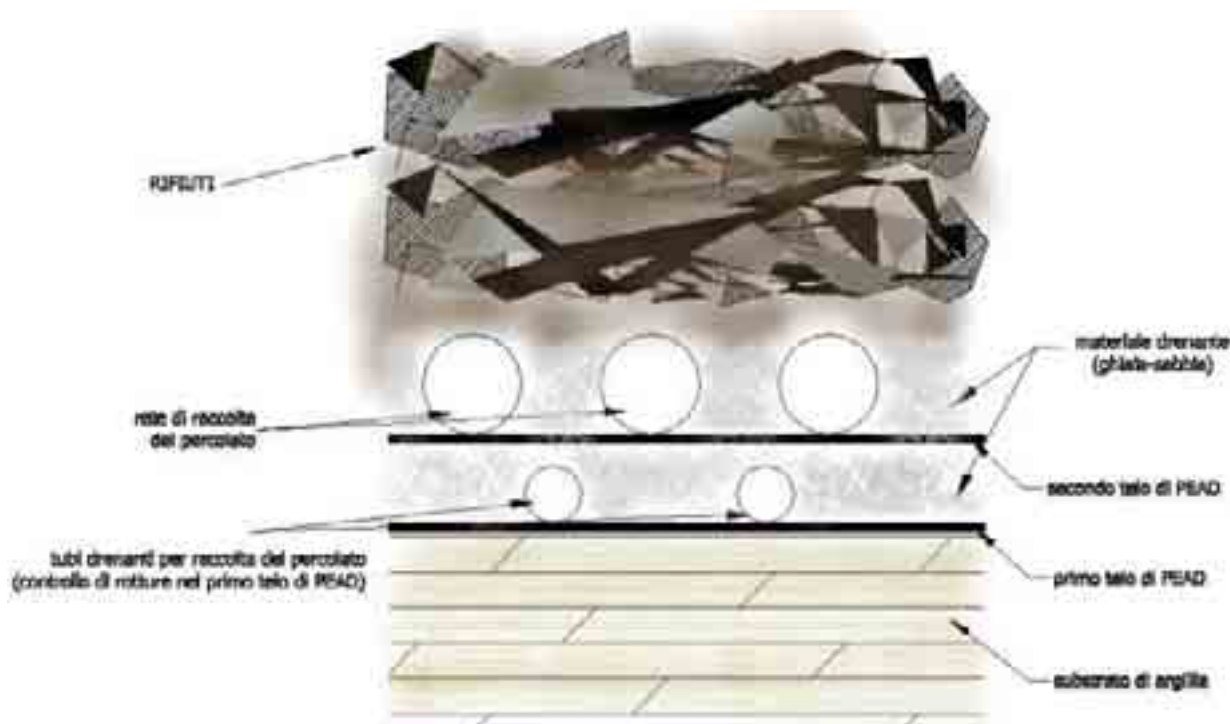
Schema dell' impermeabilizzazione del fondo della discarica
